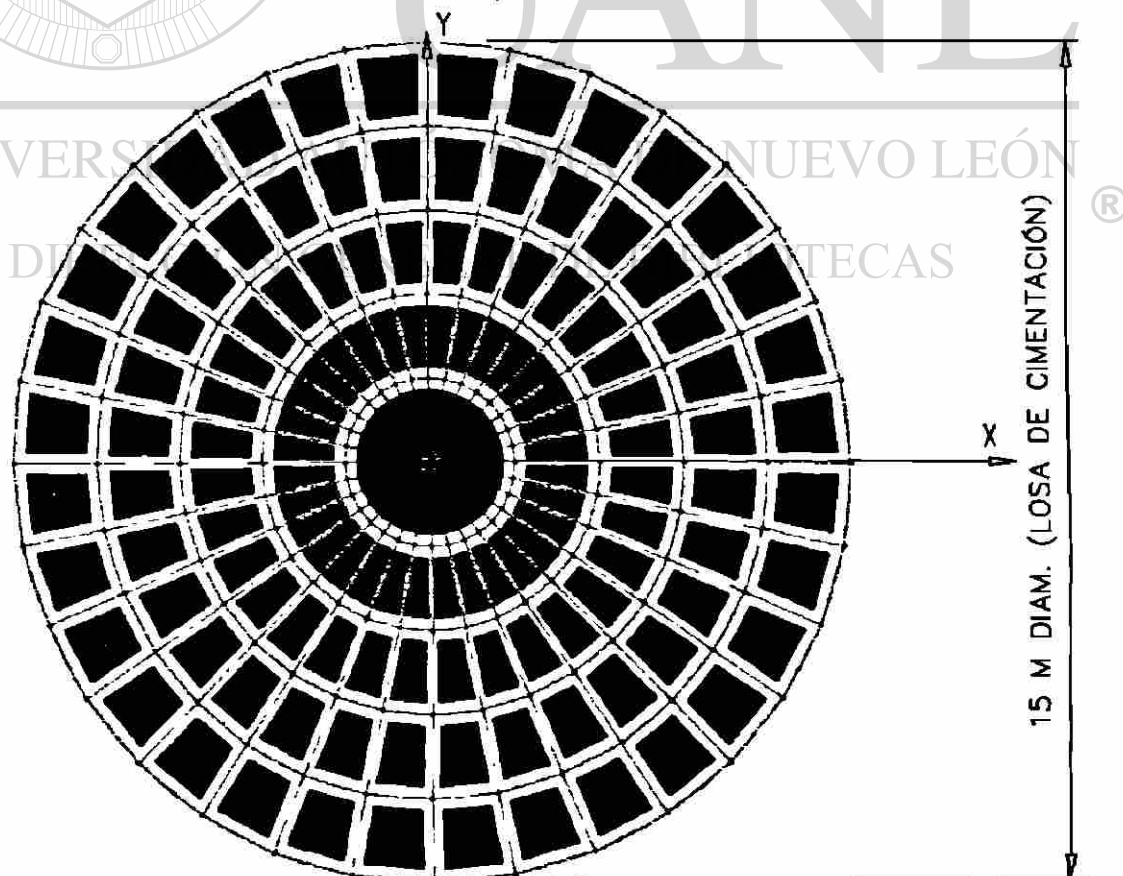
Planta de losa de cimentación de silo de 12 m de diámetro.
